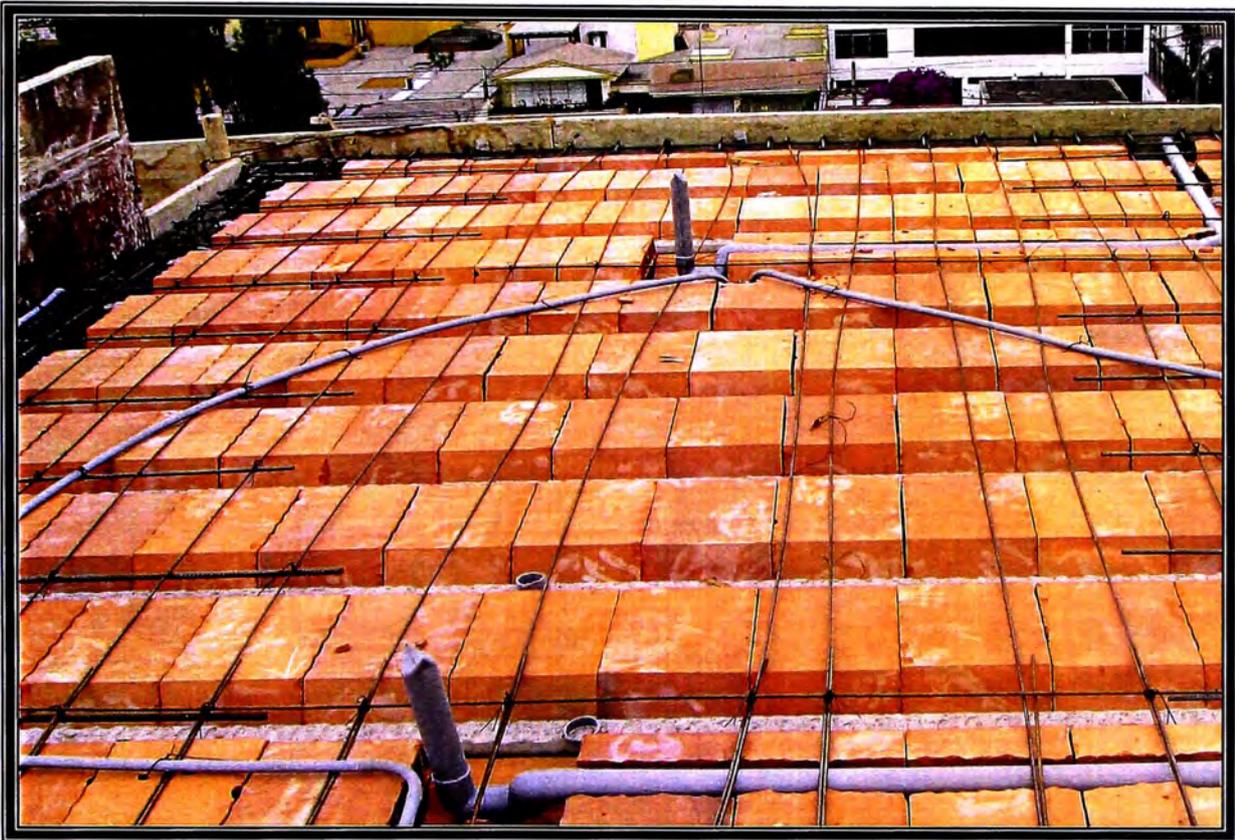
ALIGERADO DE LA ZONA DE AZOTEA LISTO PARA SER LLENADO.
